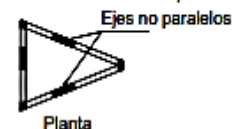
Coeficiente de configuración estructural en planta y elevación.
